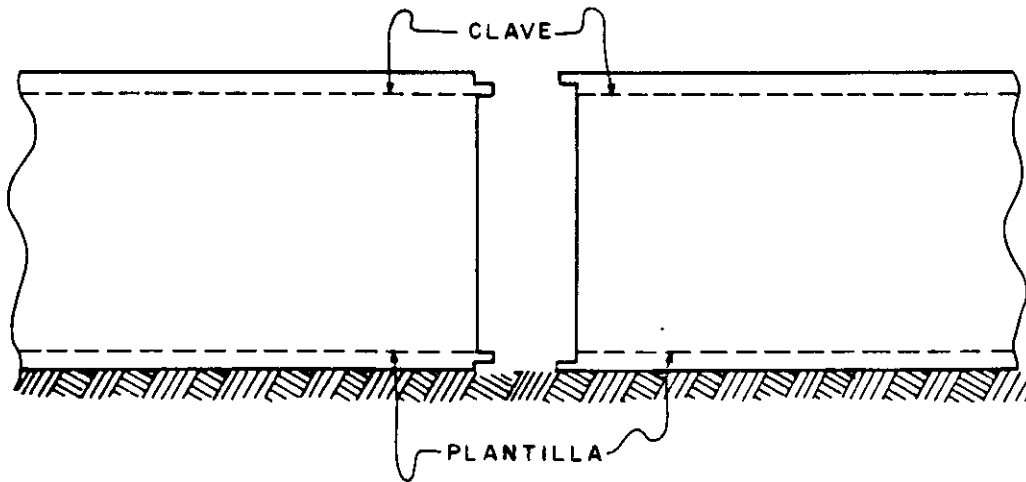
UNION EN TUBERIA DE CONCRETO REFORZADO
